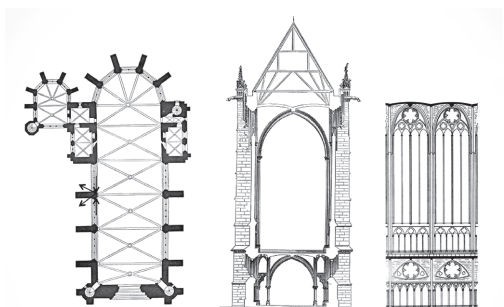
La Sainte-Chapelle (Paris). Plan, coupe, élévation
